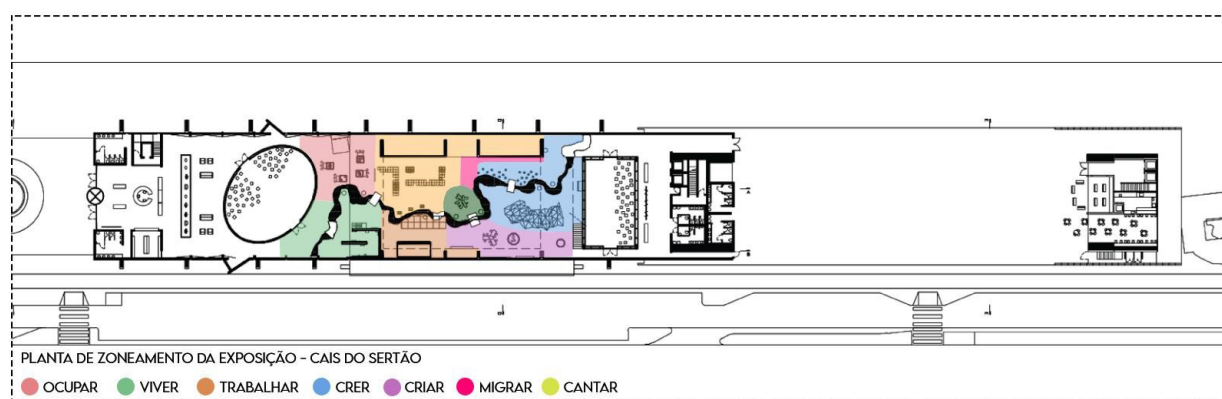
Planta baixa do pavimento térreo do Museu Cais do Sertão com setorização dos territórios temáticos.
